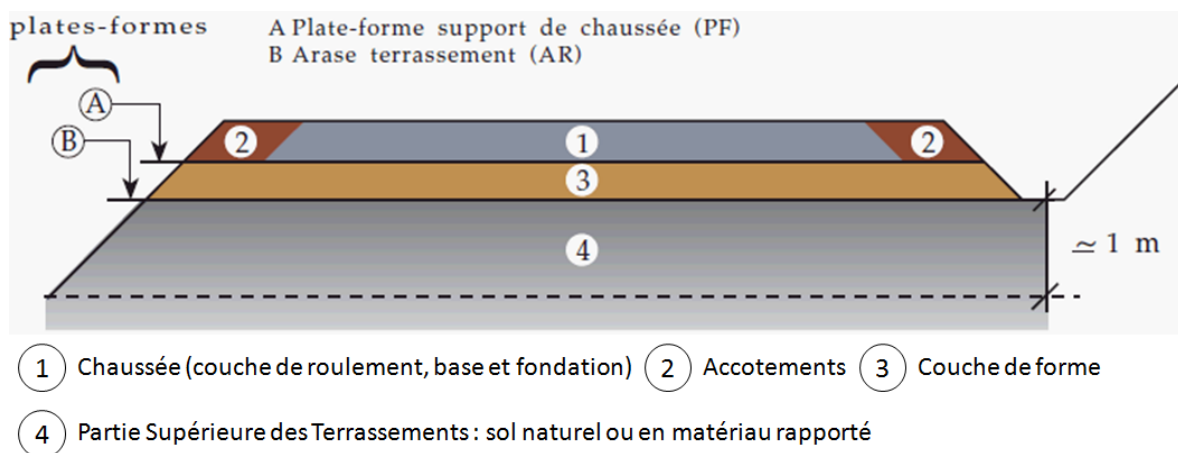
Vue en coupe 2D d'une structure de chaussée (GTR, 2000)
